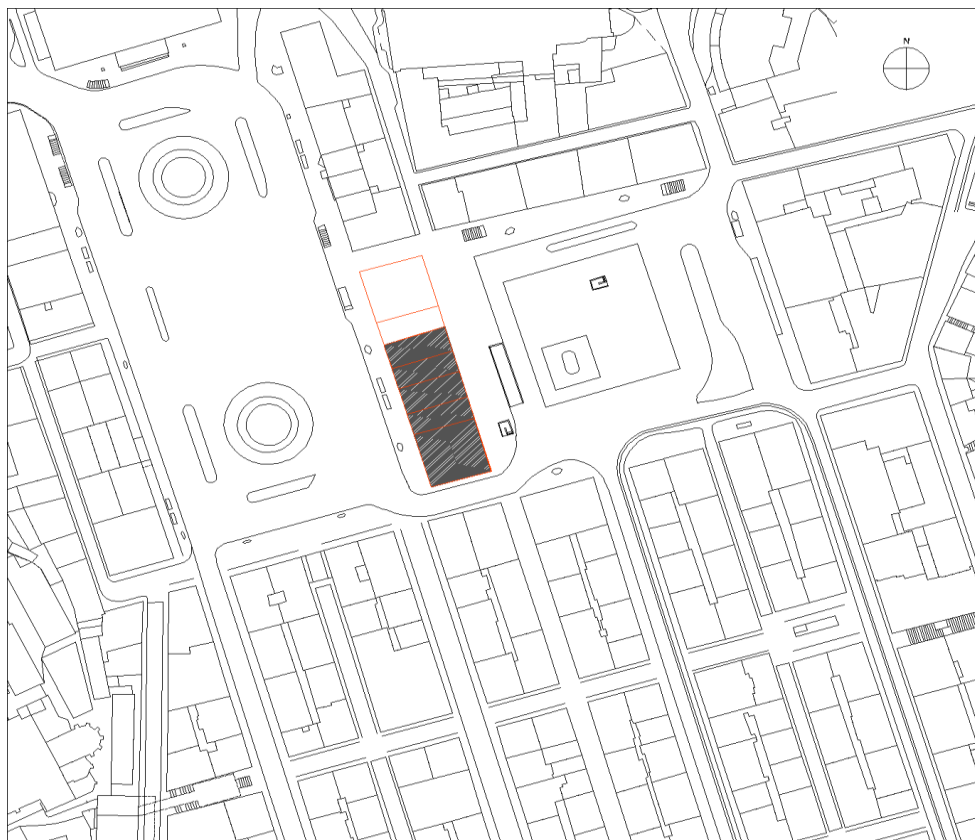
Planta de Localização - Praça da Figueira (Quarteirão do Hotel Frankfort)
